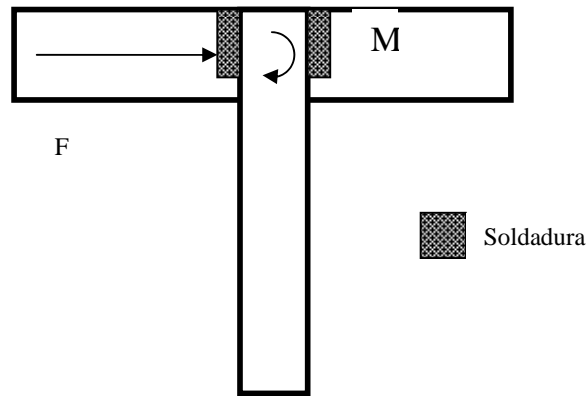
Soldadura de Viga Carril con Viga Soporte
